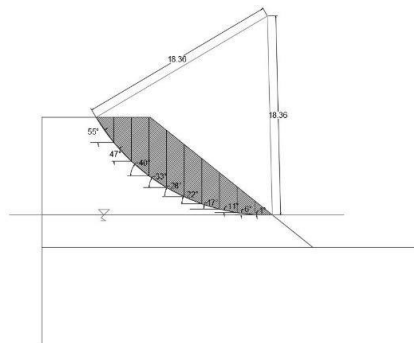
Daerah Potensial Keruntuhan Lereng Menggunakan Sheet Pile
